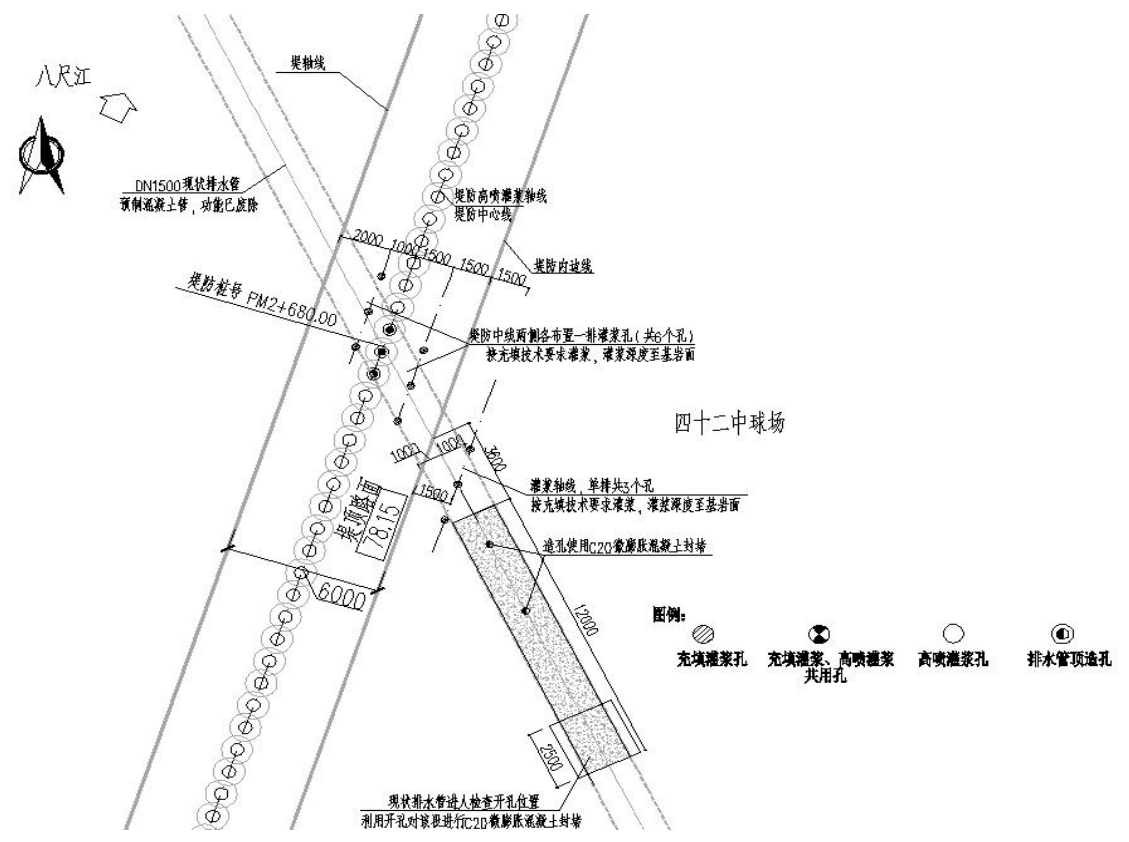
穿堤管位置堤基防渗平面布置示意图
